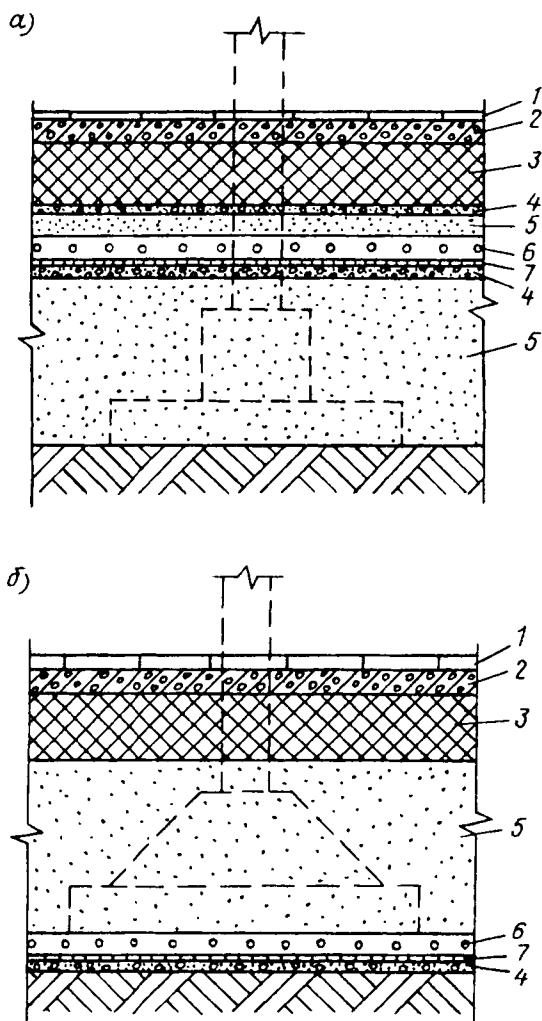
Пол с электрообогревом грунта: а — над фундаментом; б — под фундаментом;
